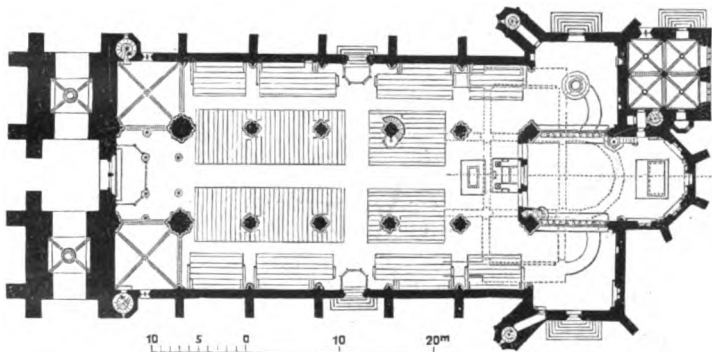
Grundriss nach der Wiederherstellung.
